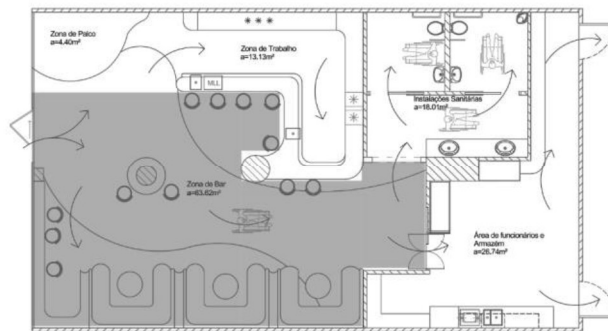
Identificação da Zona de Bar em planta (Camila Schmidt, 2025)
